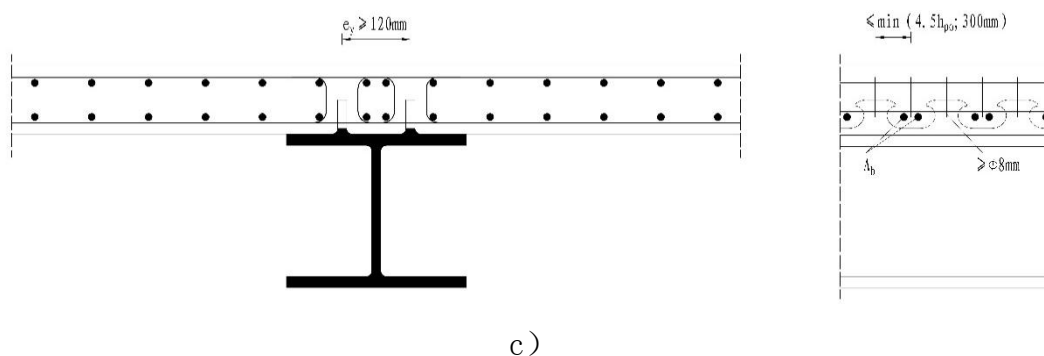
钢樨连接件的钢筋构造示意图
